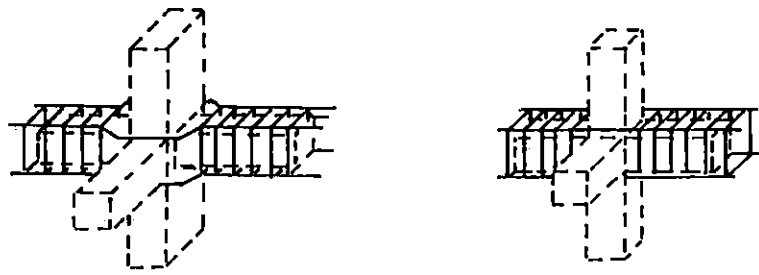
CONTINUIDAD EN EL REFUERZO LONGITUDINAL EN EL ENCAMISADO DE VIGAS
